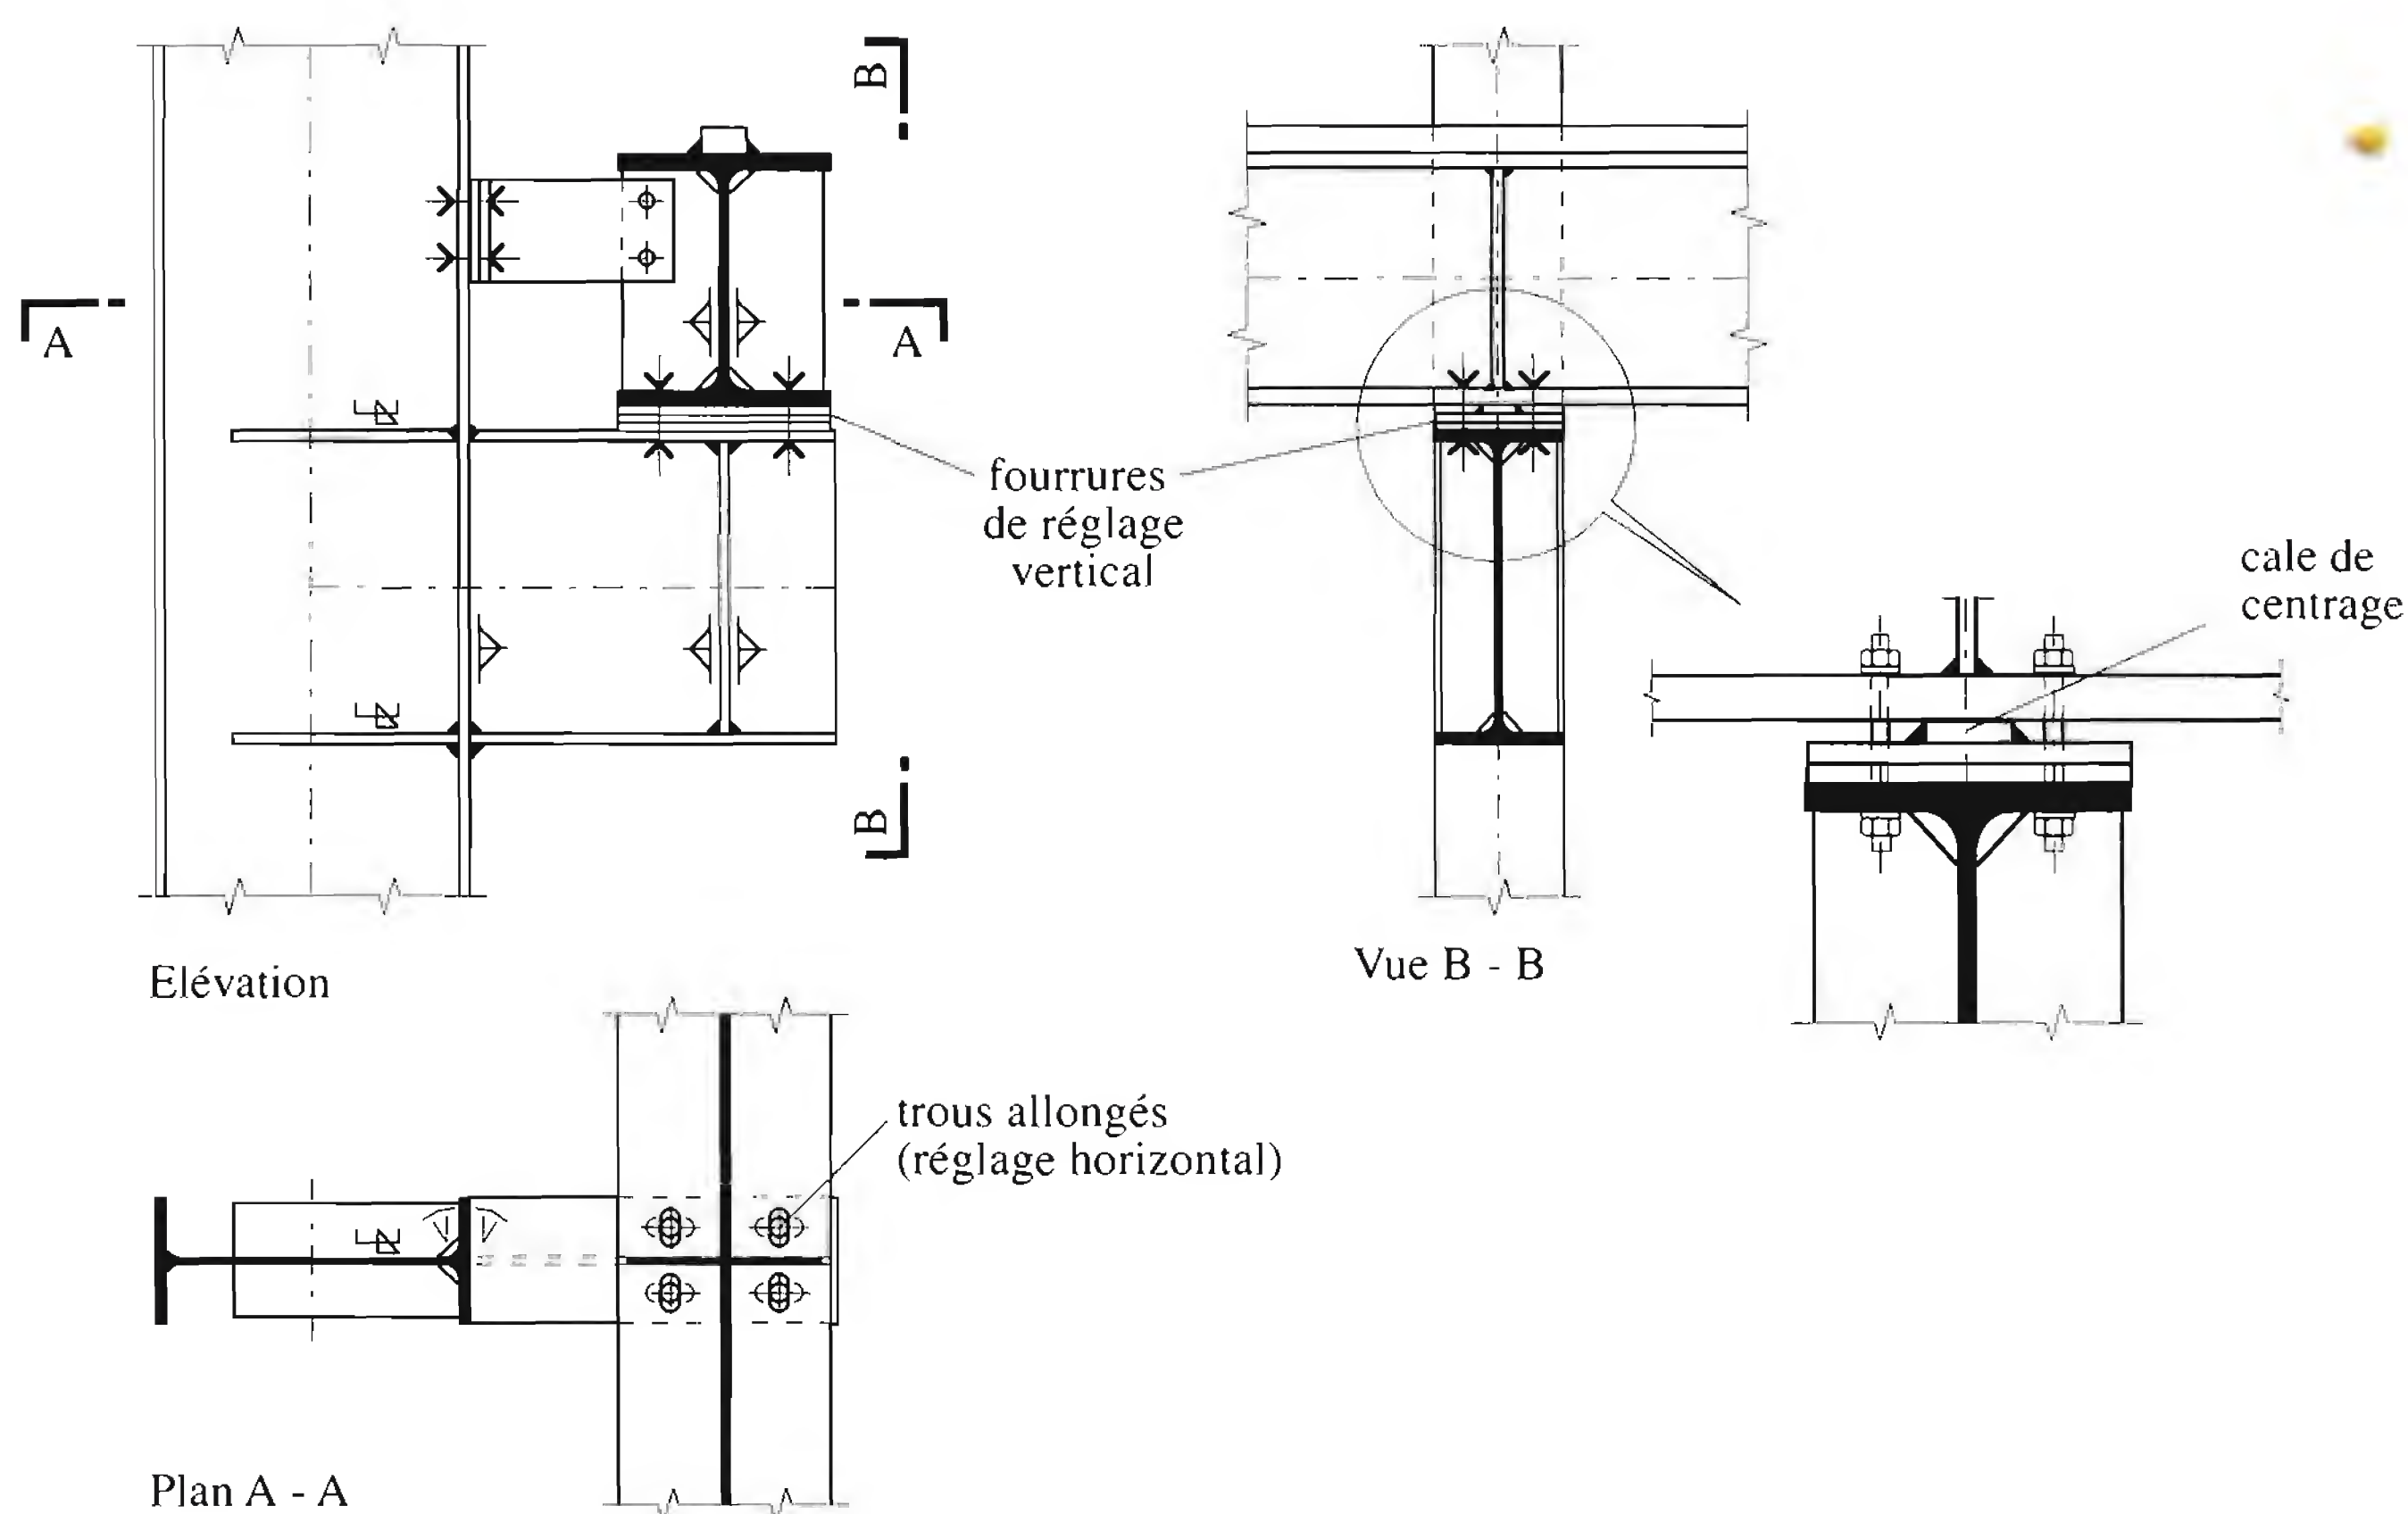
Exemple de support vertical d'une poutre de roulement.
